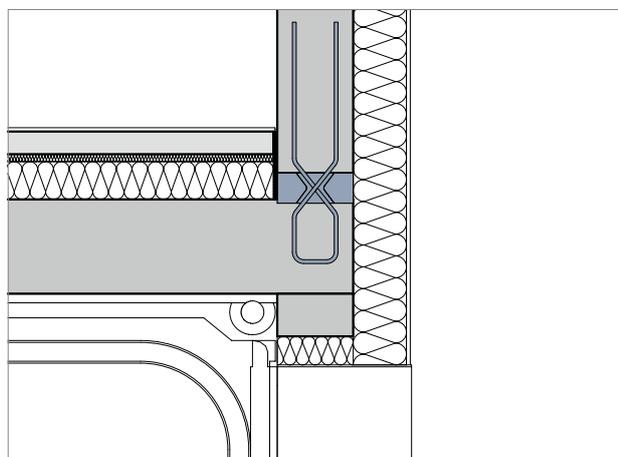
Sconnex® type W pour mur extérieur et isolation sur la dalle au-dessus d'une entrée de garage souterrain
